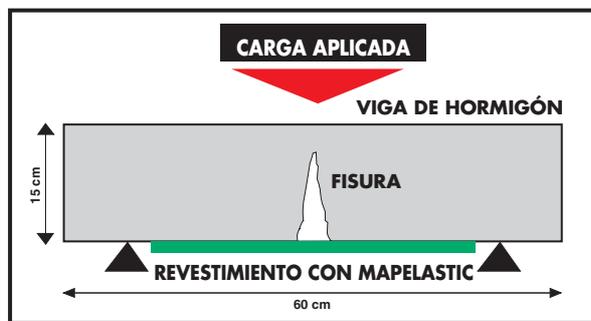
Protección con Mapelastic de una fisura en el intradós de una viga de hormigón sometida a una tensión por flexión
